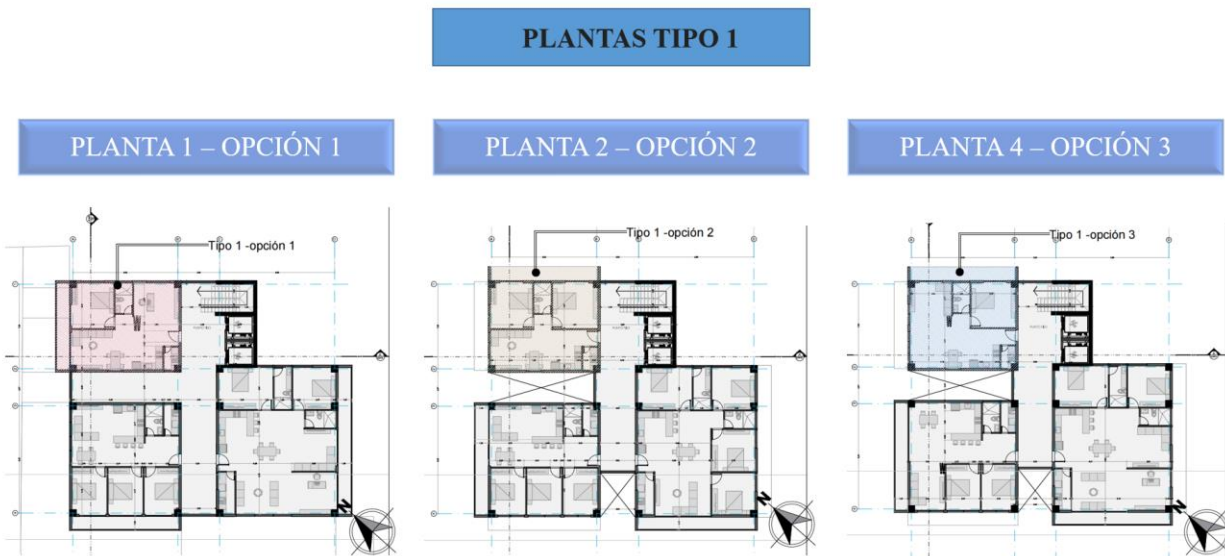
Plantas y cortes vivienda tipo 1 – Zonificación
